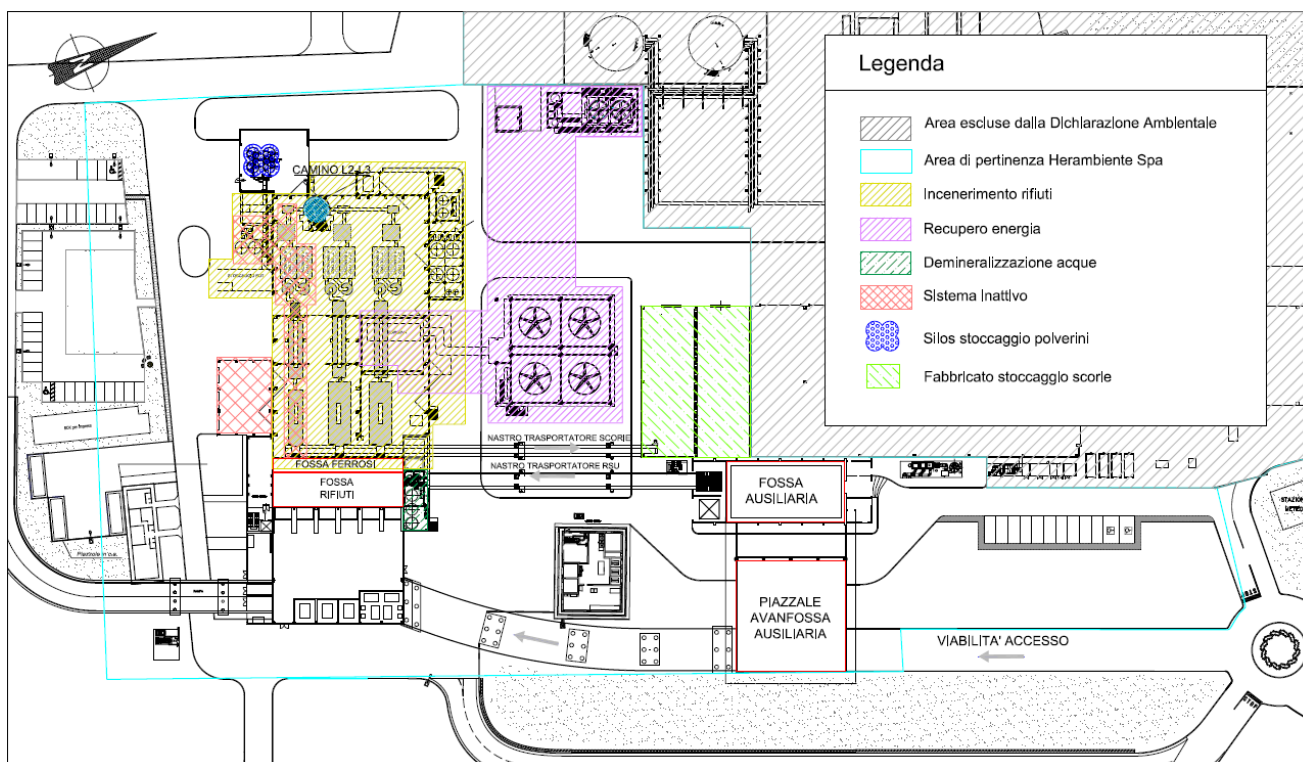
Planimetria di dettaglio dell'impianto di termovalorizzazione
